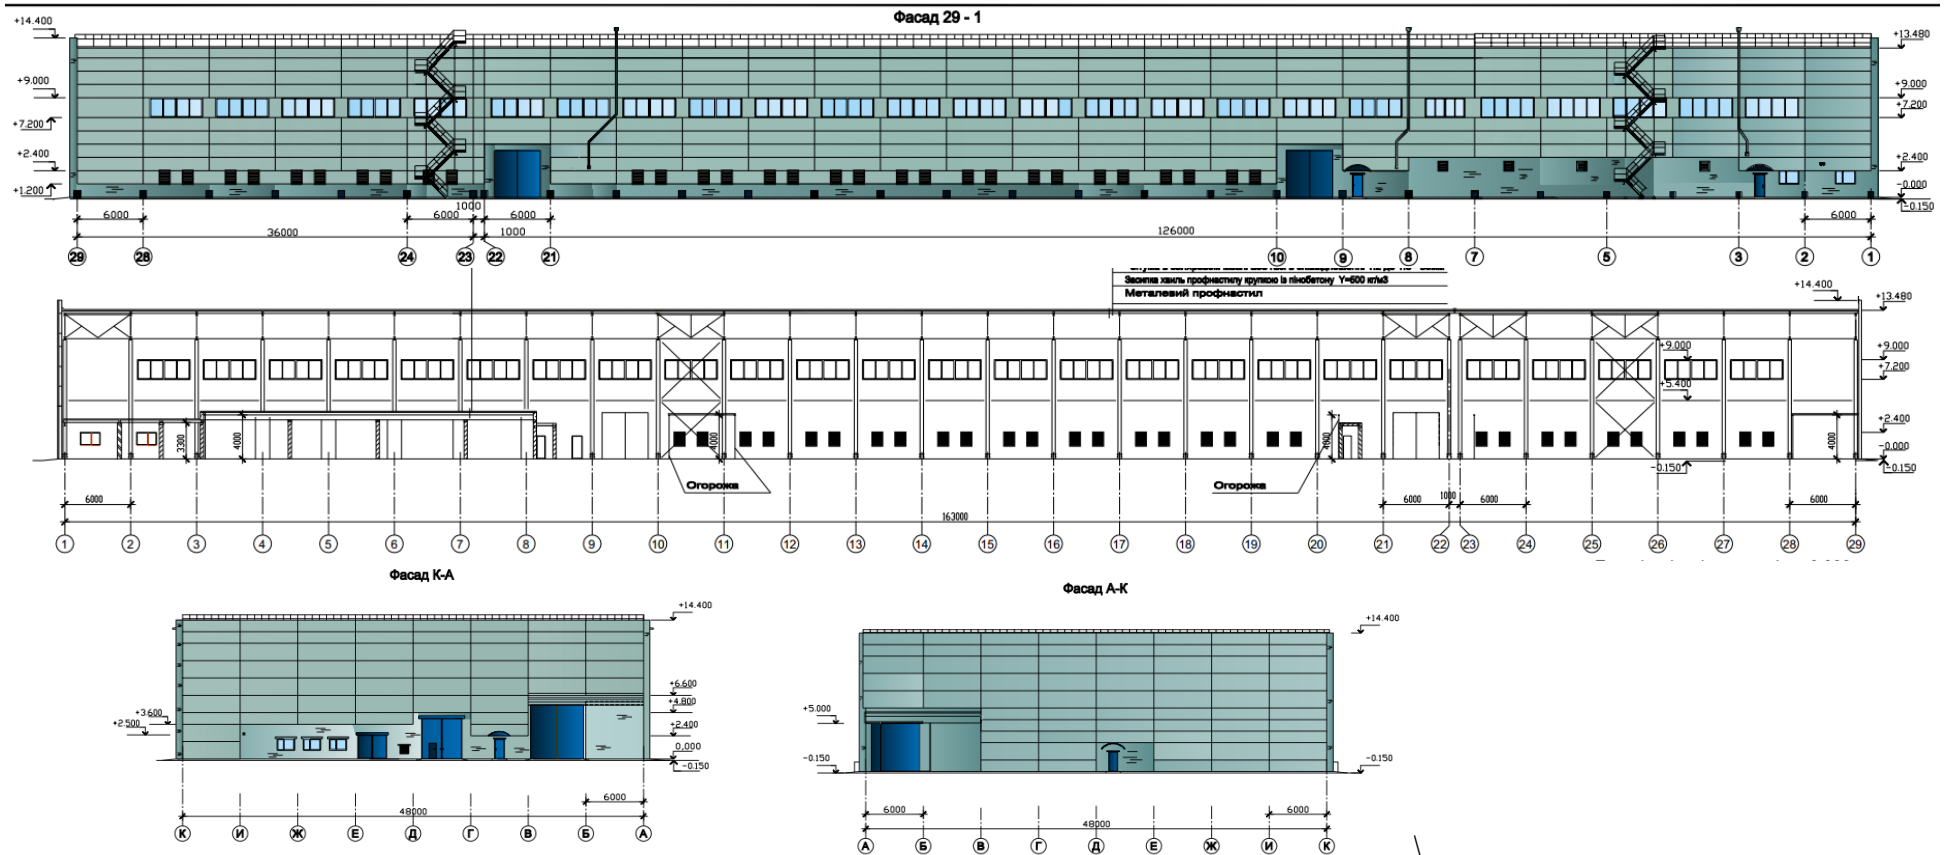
Фасади та повздовжній розріз промислової будівлі
